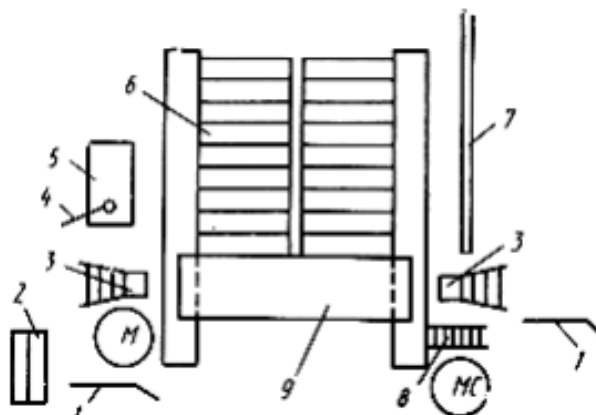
Схема организации рабочего места при монтаже лестничных площадок и лестничных маршей МС- рабочее место рабочего, выполняющего монтажные работы, старшего в звене, М- рабочее место рабочего, выполняющего монтажные работы, 1- монтажный лом, 2 -ящик с ручным инструментом, 3- площадка для сварщика и монтажника, 4- растворная лопата, 5- ящик-контейнер с раствором, 6- лестничные марши, 7 - шаблон для выверки площадки, 8- лестница для подъема на следующий этаж, 9- монтируемая площадка
